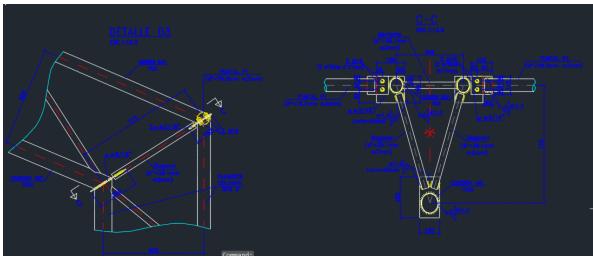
Detalles de uniones para cubierta – proyecto parque este
